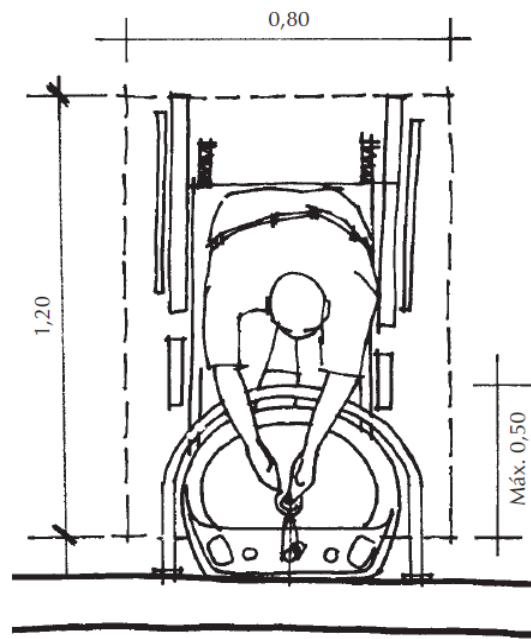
Aproximação frontal de cadeirante (SMPED, 2008).
